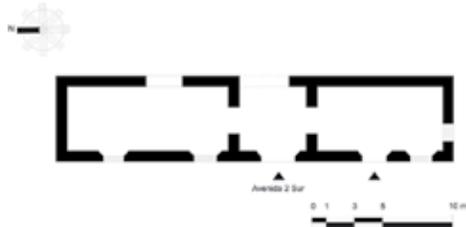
Planta Av. 2 Sur esquina con Calle 2 Oriente. Dibujo de David Pérez Fernández.
